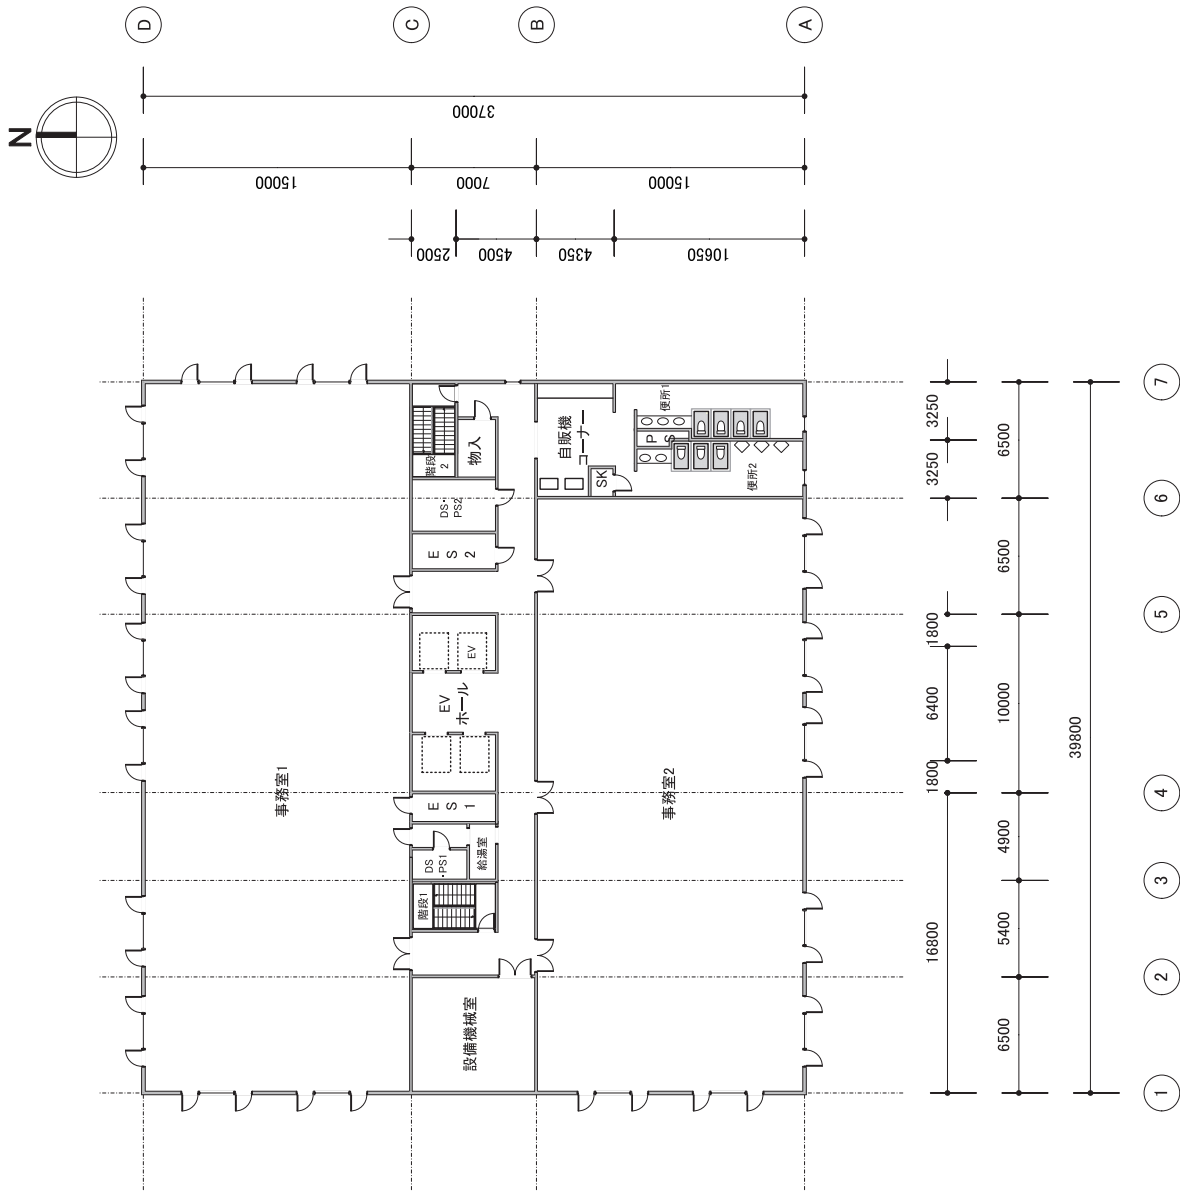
A.2 モデル建物（事務所等、10,000 m<sup>2</sup>） 2～7 階平面図
